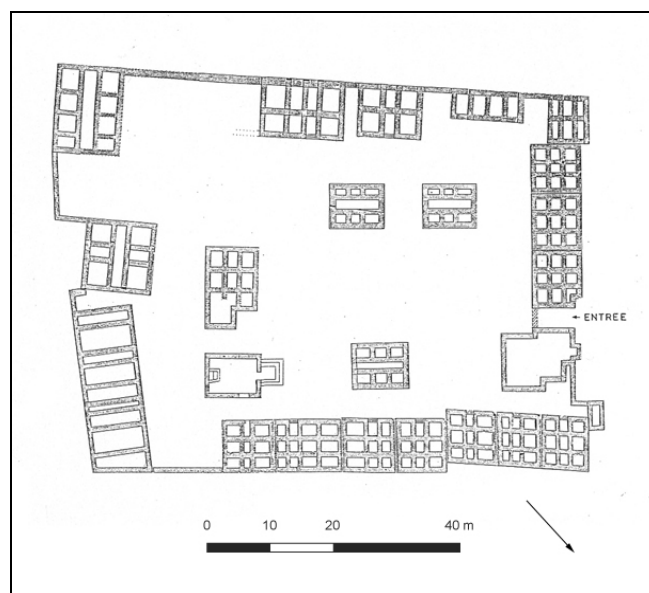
plan de Hajar Khamûma (J.-F. Breton, 1985, fig. 53).
